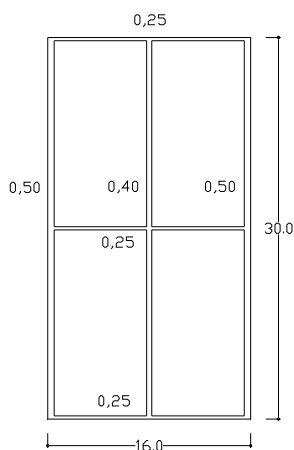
Planta tipo do edifício de alvenaria e espessuras das paredes.
